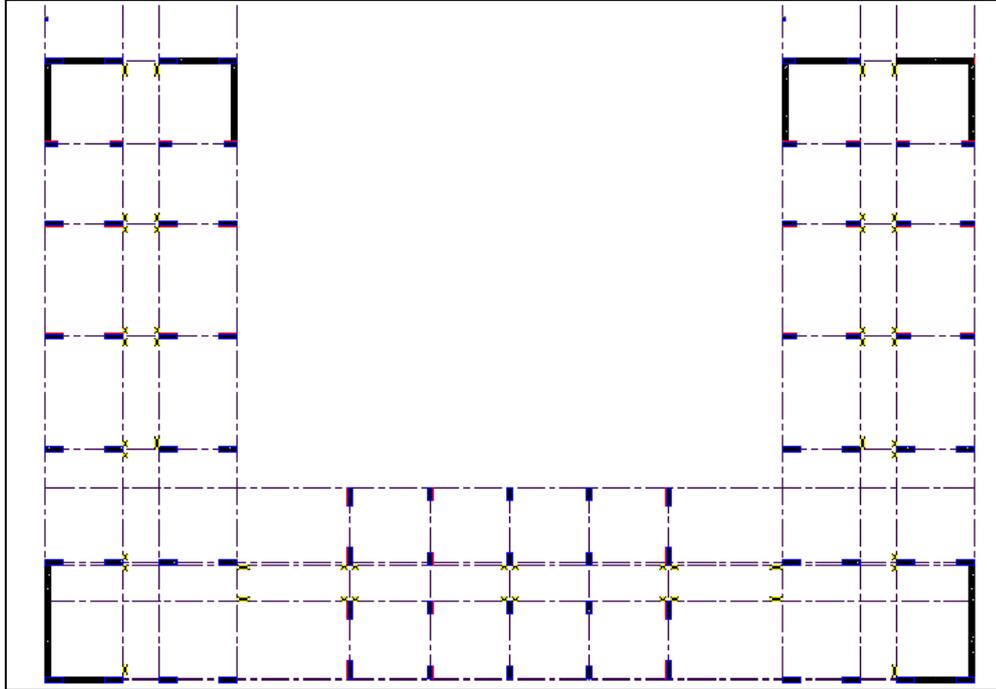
Denah Kolom dan Dinding Geser Eksisting Lantai Dasar Sampai Lantai 13 Tipe B
